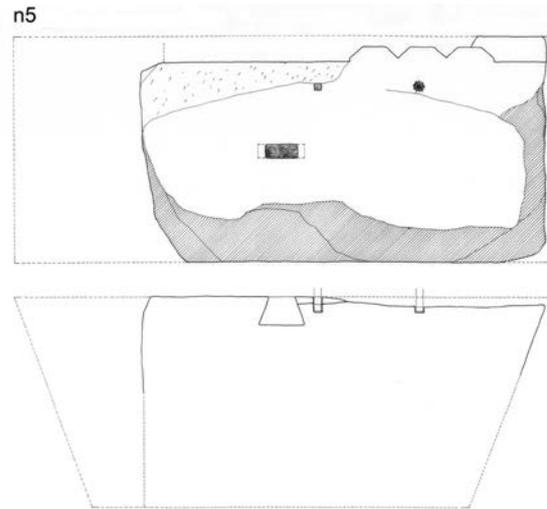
Spoleto, basilica di San Salvatore. Navata centrale: piattabanda n. 5 inglobata nel primo pilastro a Sud e piattabanda n. 6 nel primo a Nord. Pianta del letto di attesa e sezione longitudinale.
